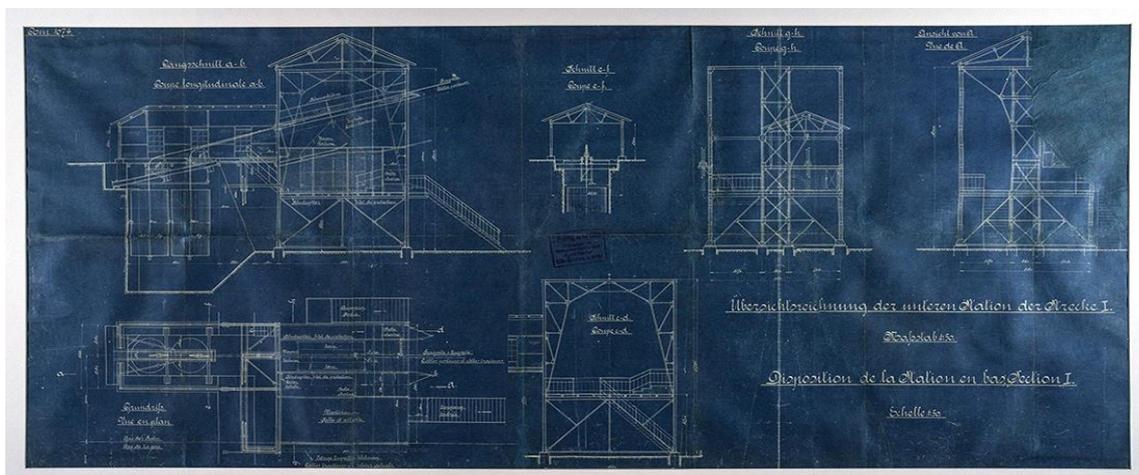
Cópia heliográfica da planta restaurada da 1ª Estação do Bondinho do Pão de Açúcar. FONTE: Acervo CCAPA.
